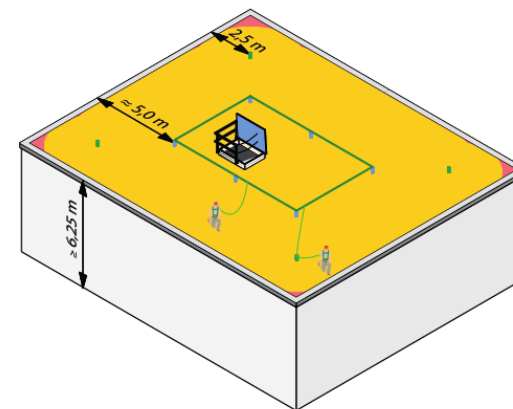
Ausstattungsklasse 2: Ein Sturzauffangsystem kombiniert mit EAP in den Ecken
